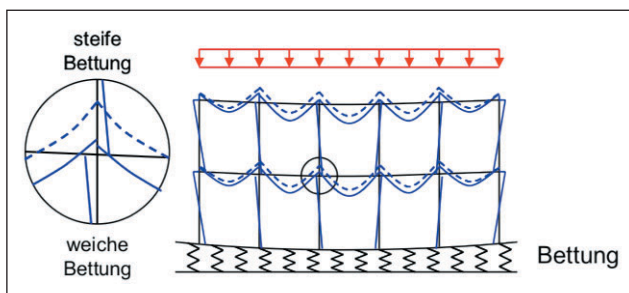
Einfluss der Bettung auf Systemschnittgrößen
